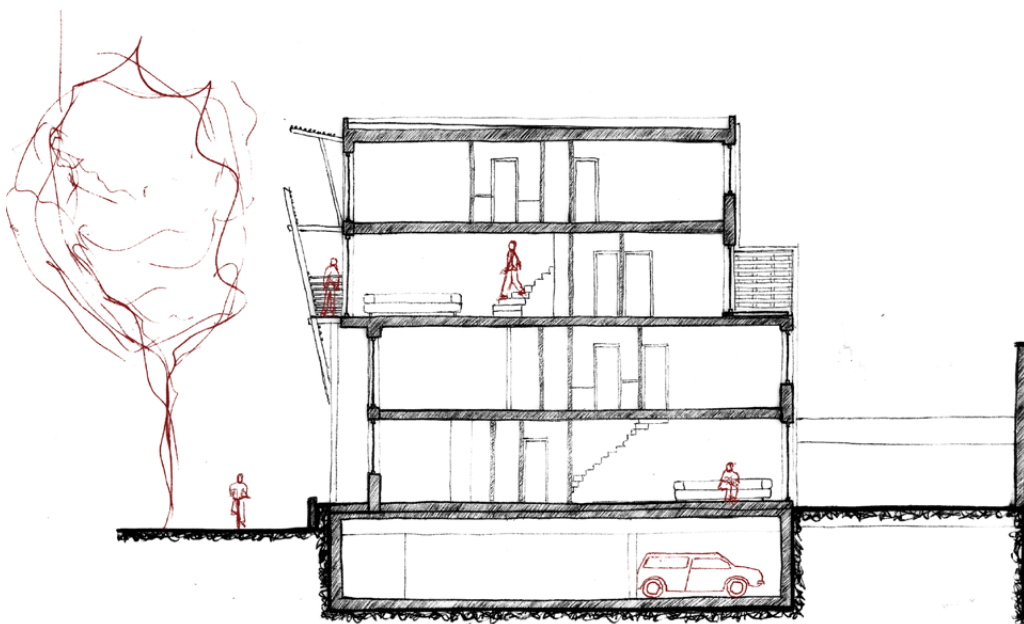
Sección transversal B-B' l'Espoir Bursseles
